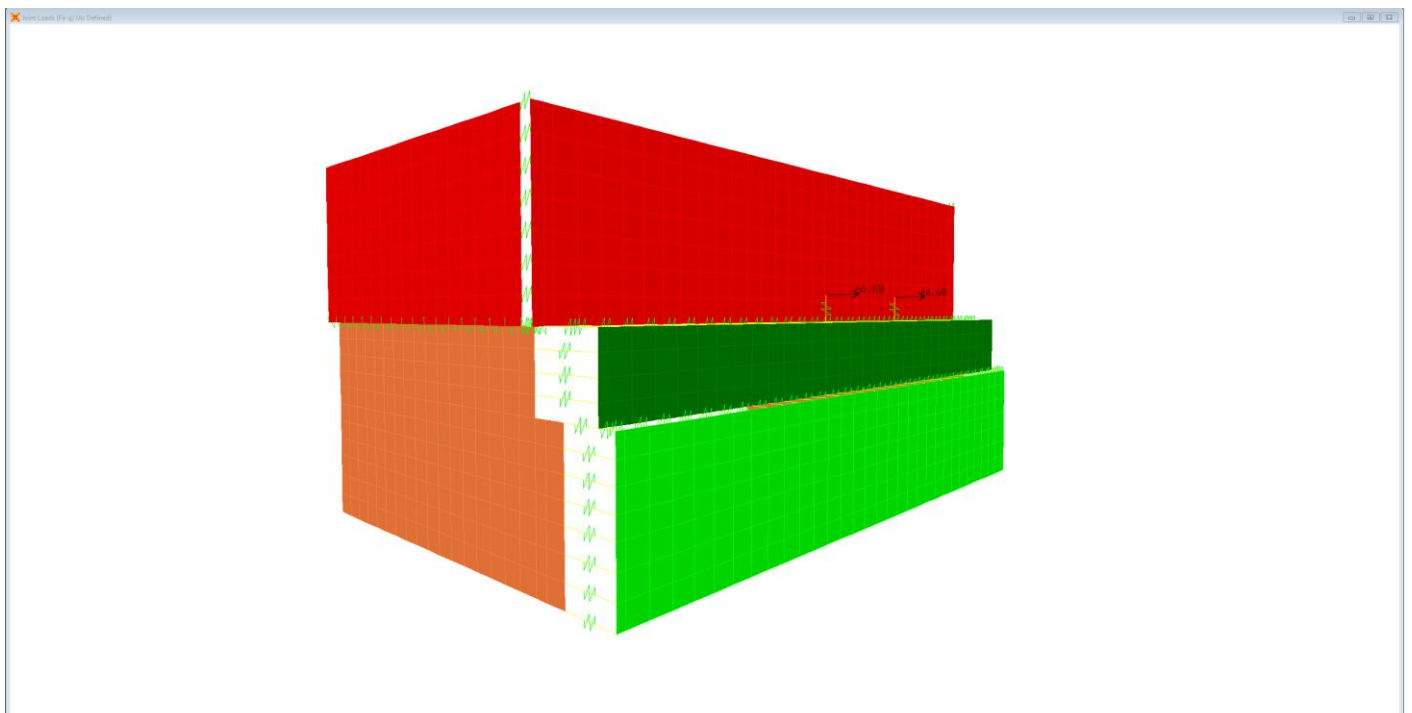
Elevazione SPALLA A – Fa-q
